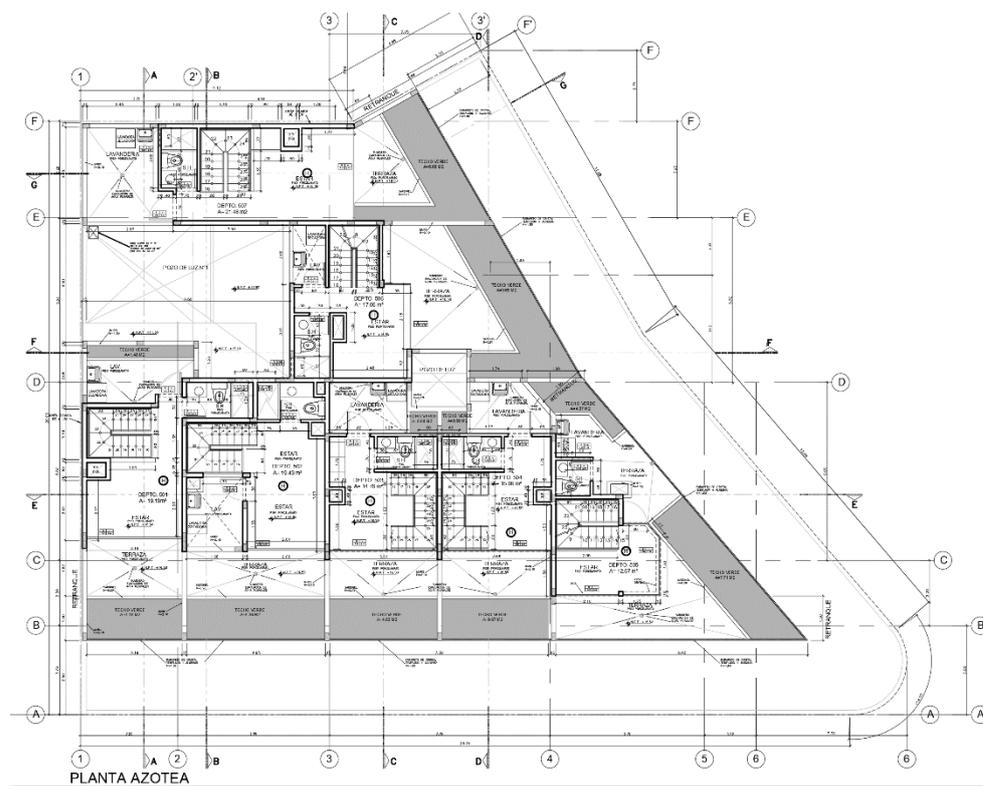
Planta del 6to piso - triplexFuente: Propia*Figura 24*Planta Azotea - triplexFuente: Propia
